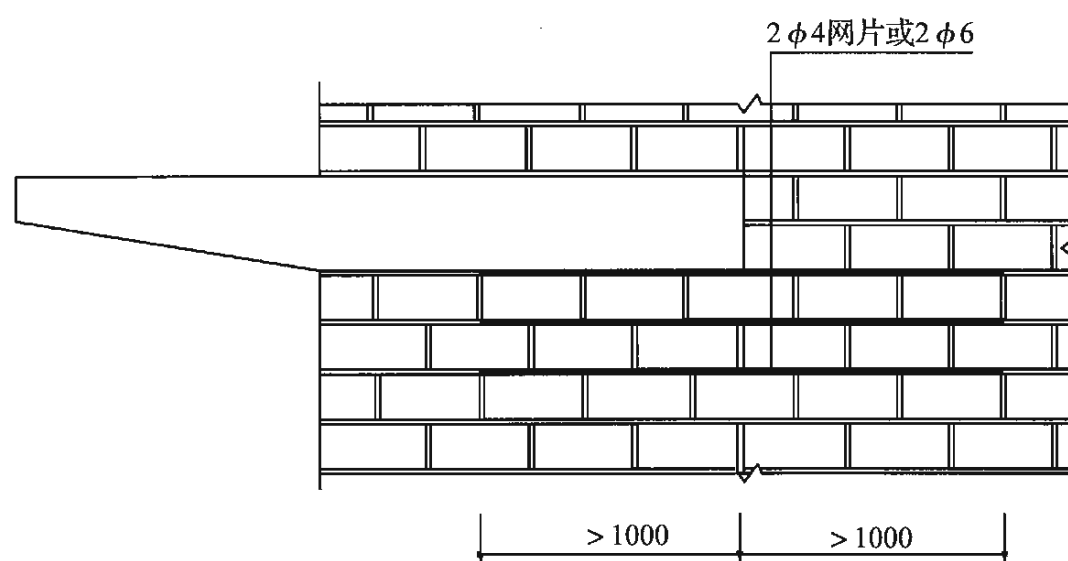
挑梁末端下墙体内设置3道焊接钢筋网片
